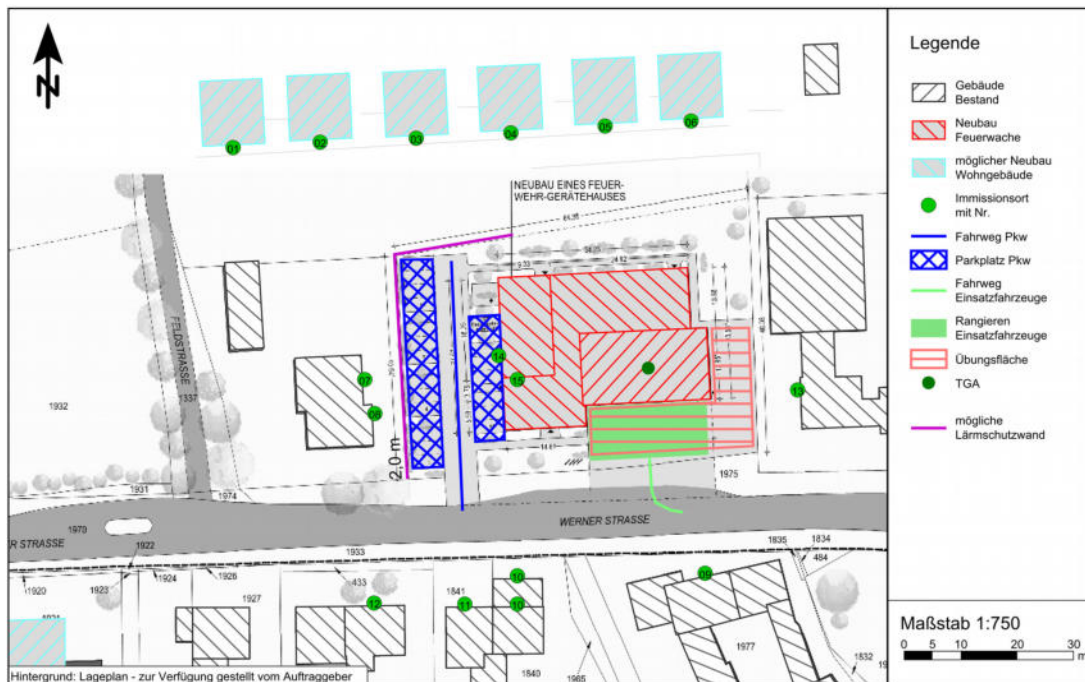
Lageplan mit Darstellung der Ersatzschallquellen
